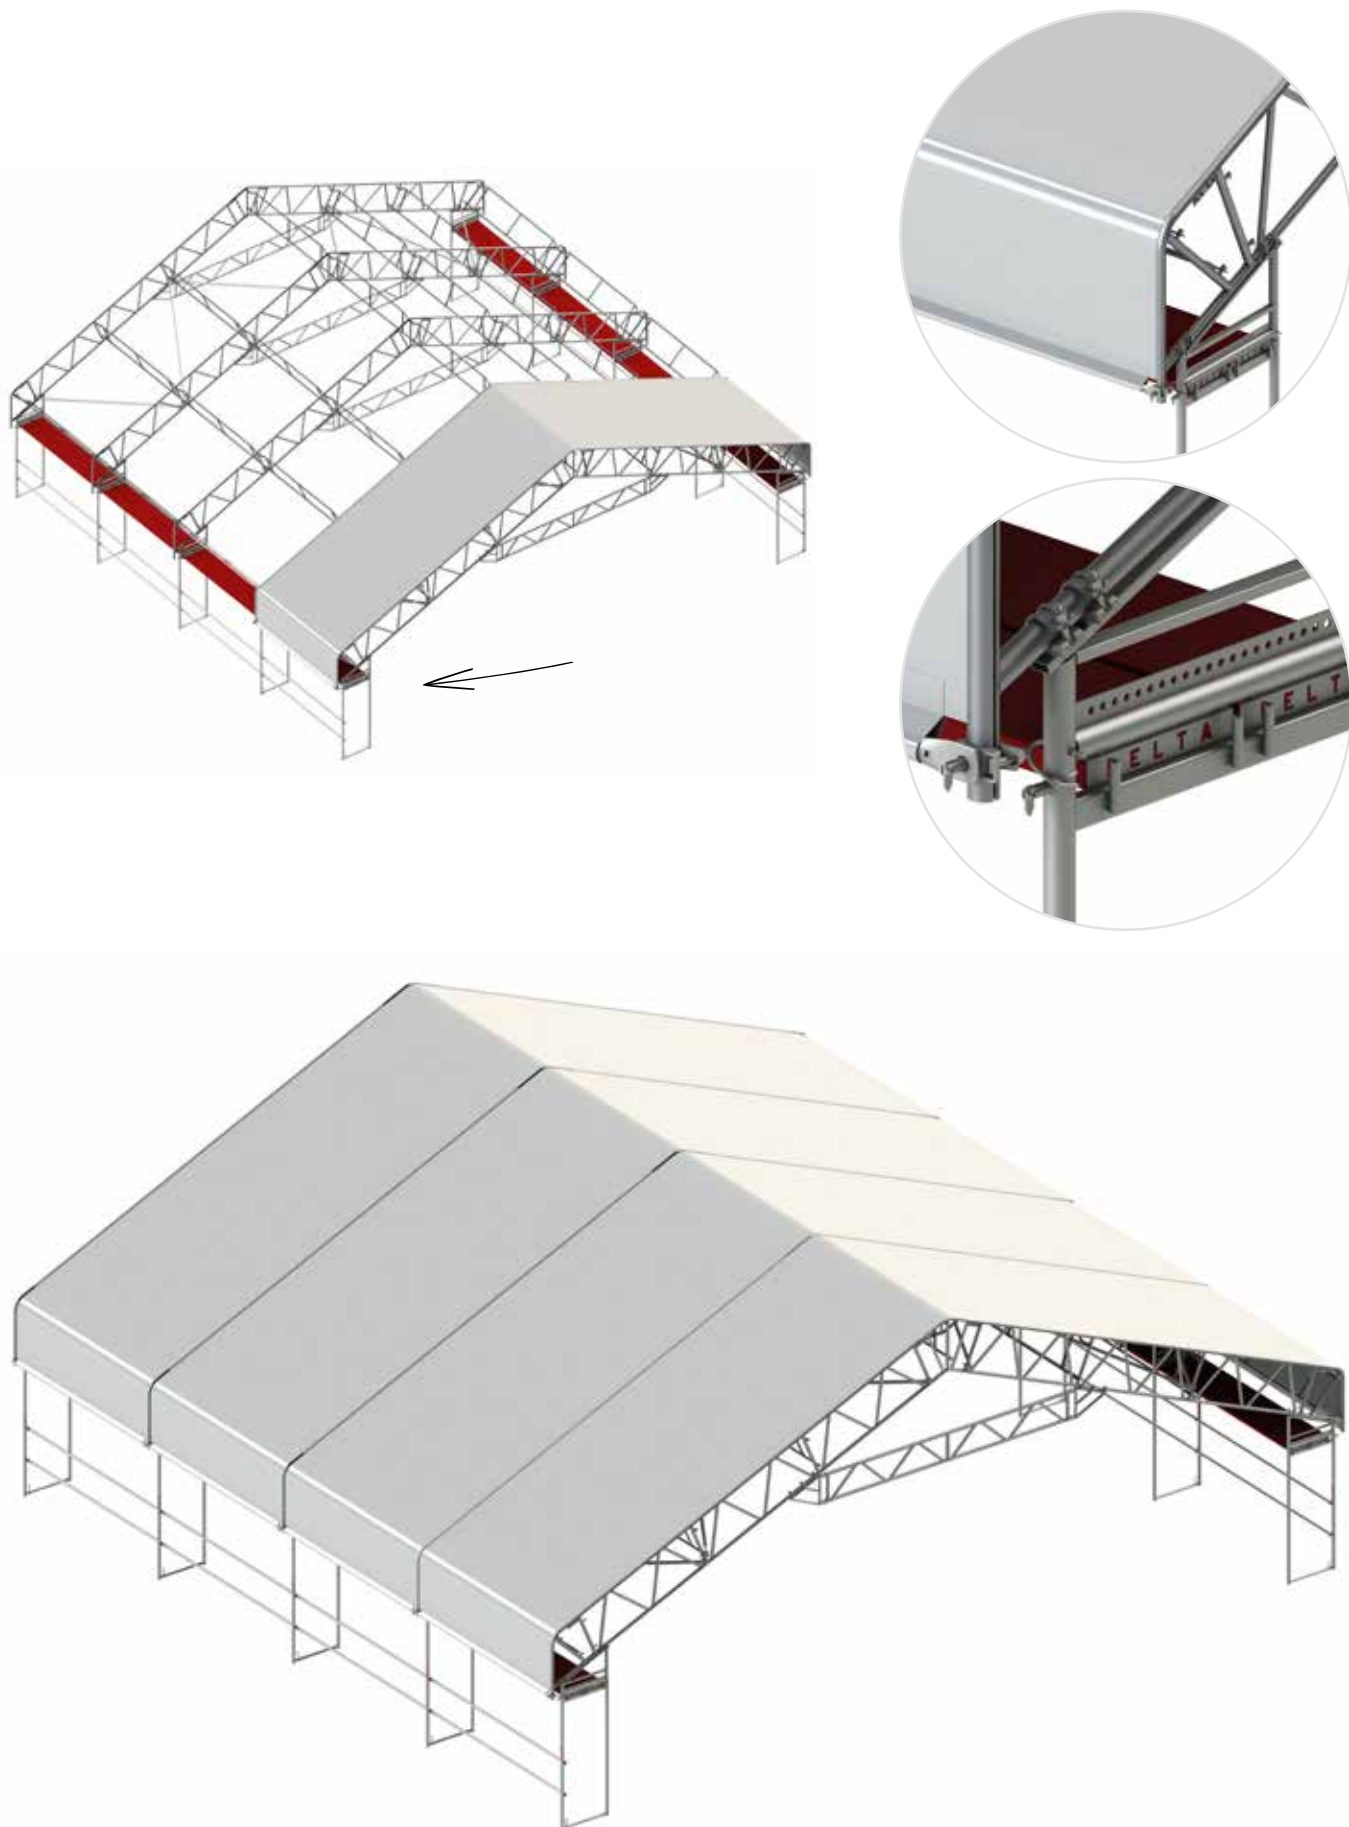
Przykładowe etapy montażu dachu z wykorzystaniem dźwigu.
